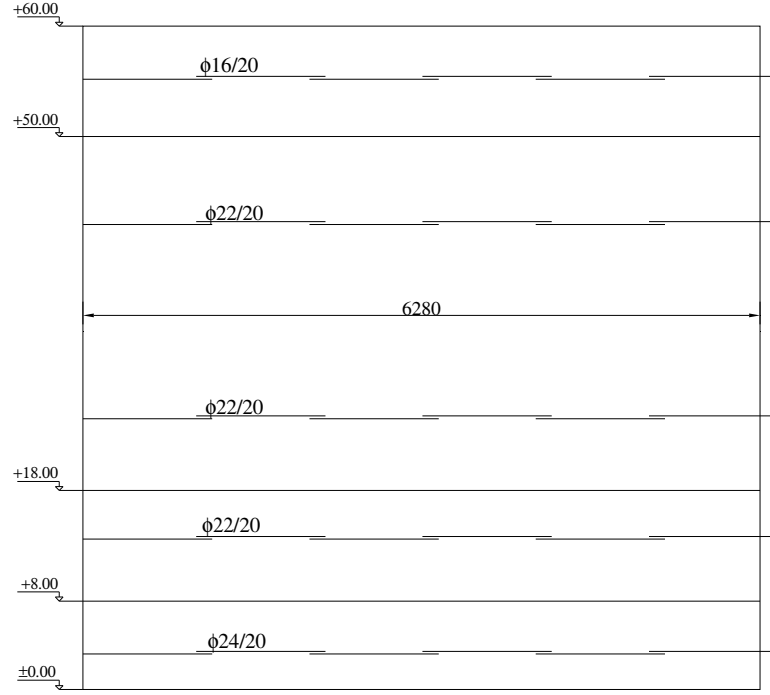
±0.00 - 8.00m Arası Silo Perdesi Donatı Kesit Planı
